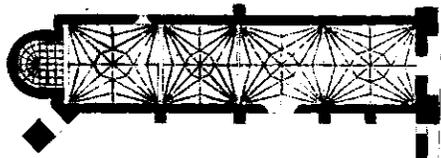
Planta de la nave del templo de Yanhuitlán (Barajas).
